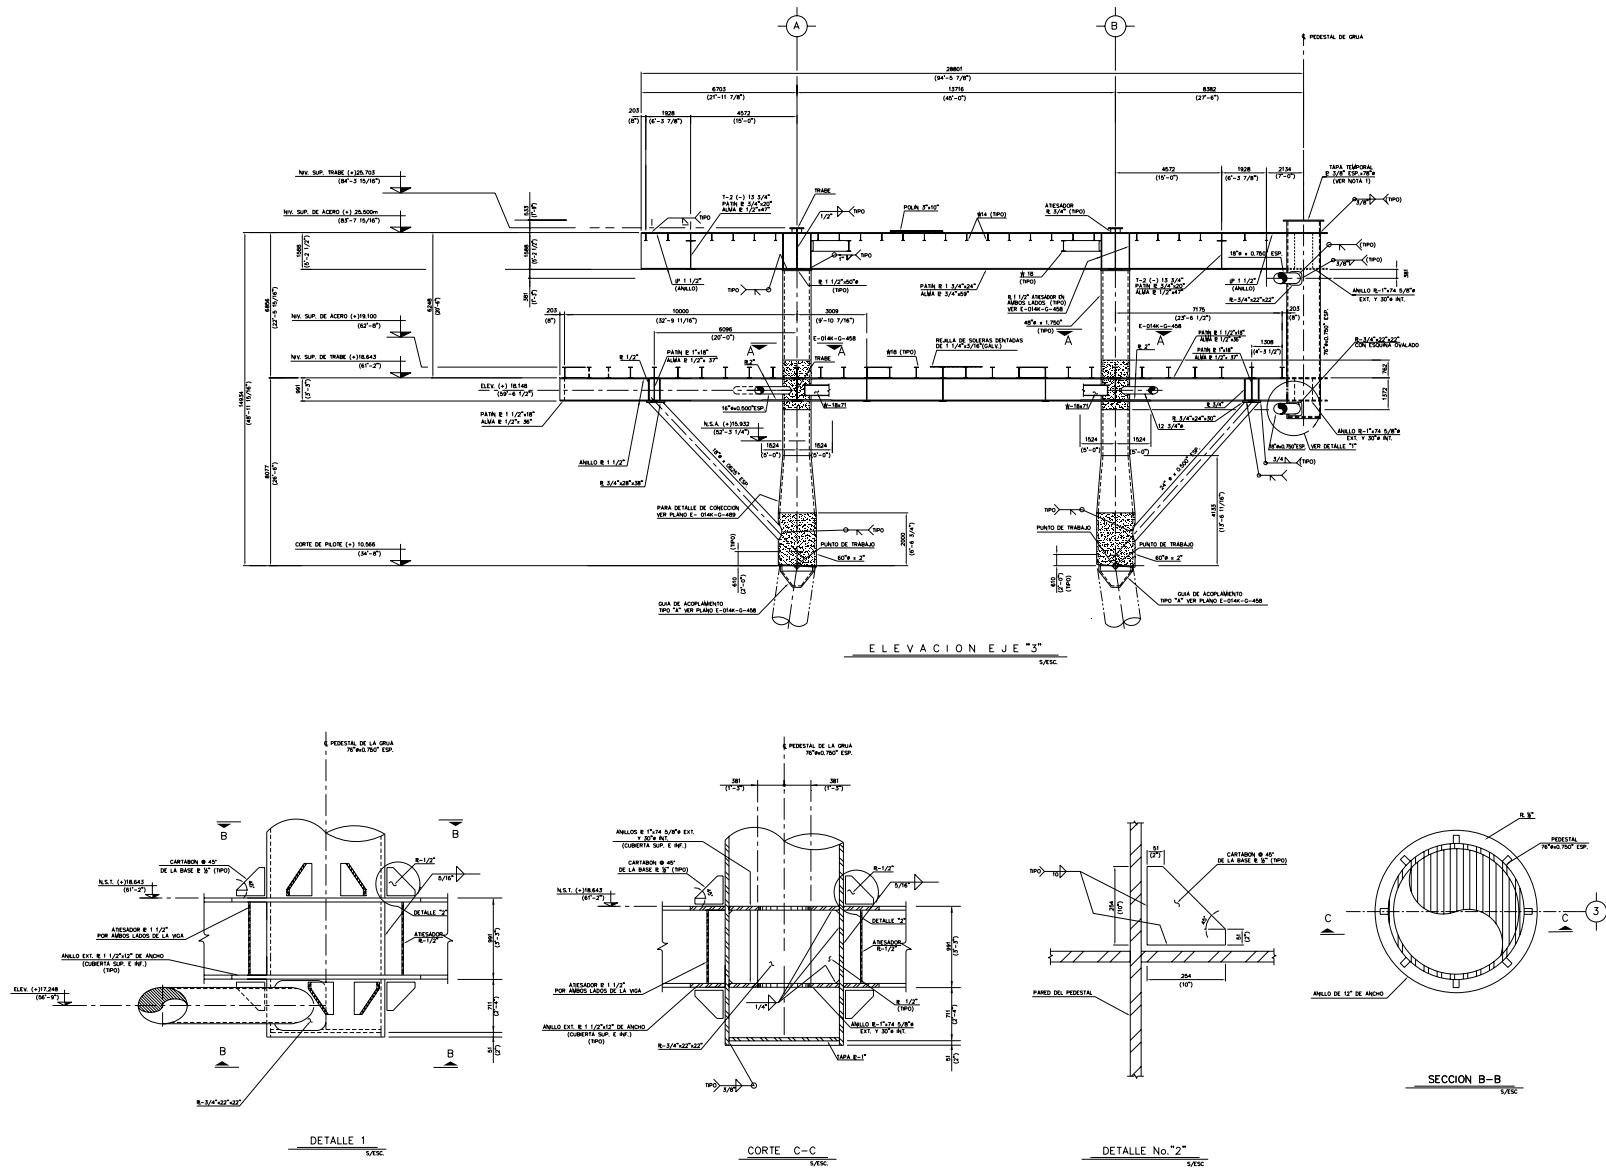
Superestructura elevación eje "3" y detalles (figura de referencia 12).
